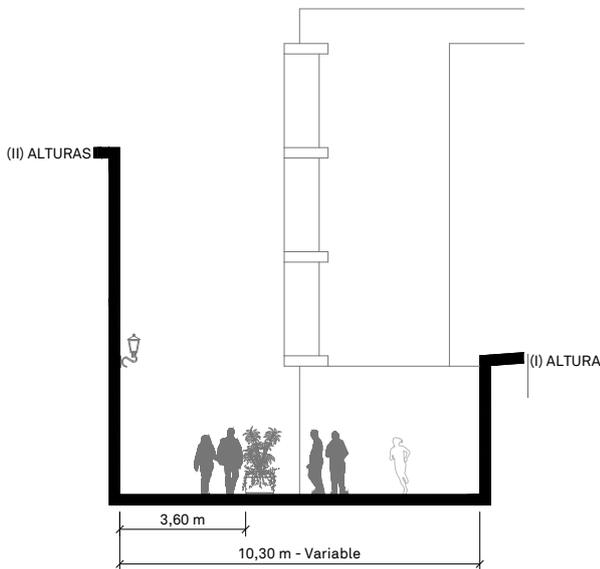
y 126. Final de la calle Benifayó. Elaboración propia.
